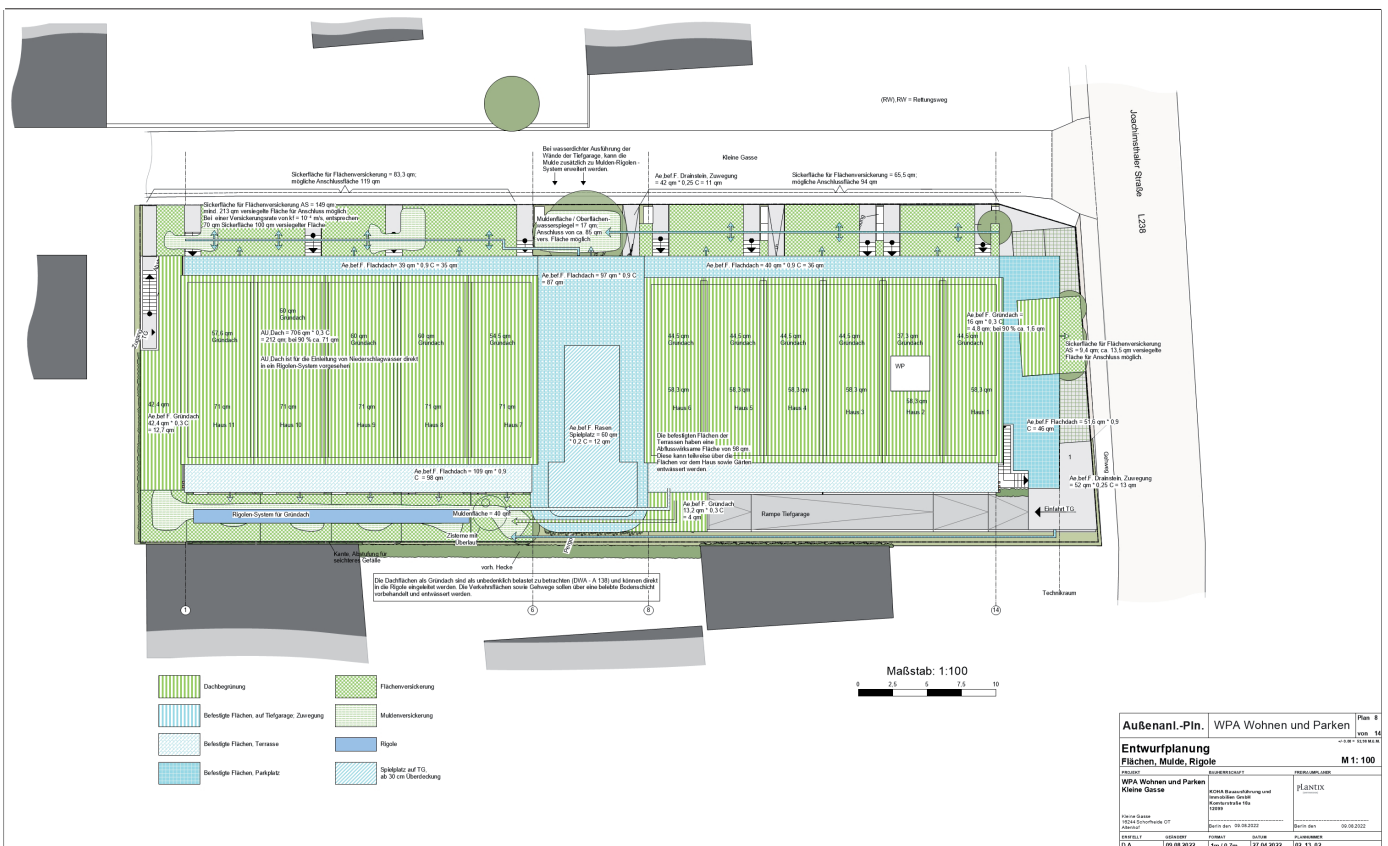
Außenanlagenplan Flächen. Mulden, Rigole
